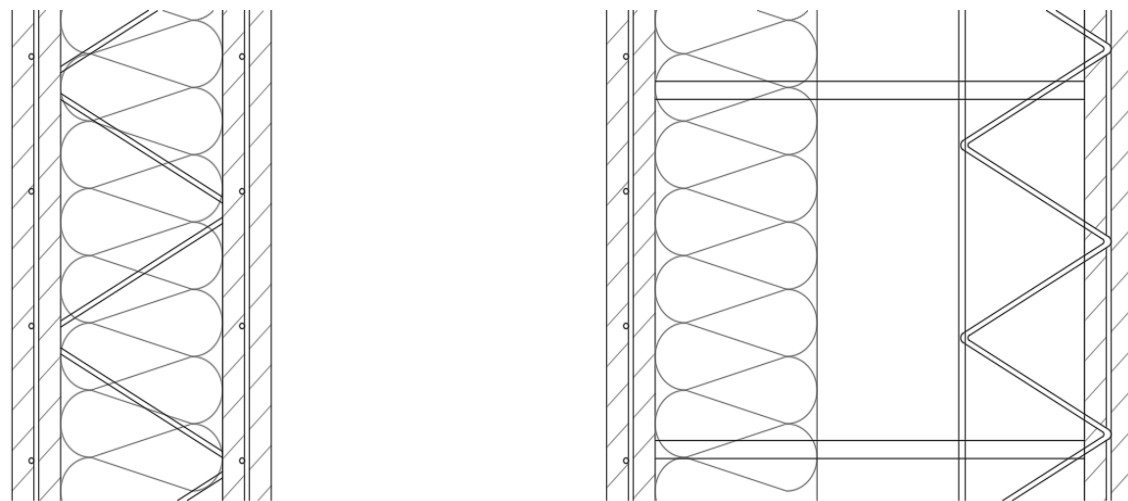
PROTOTIPO MURO PREFABRICADO TIPO SANDWICH
